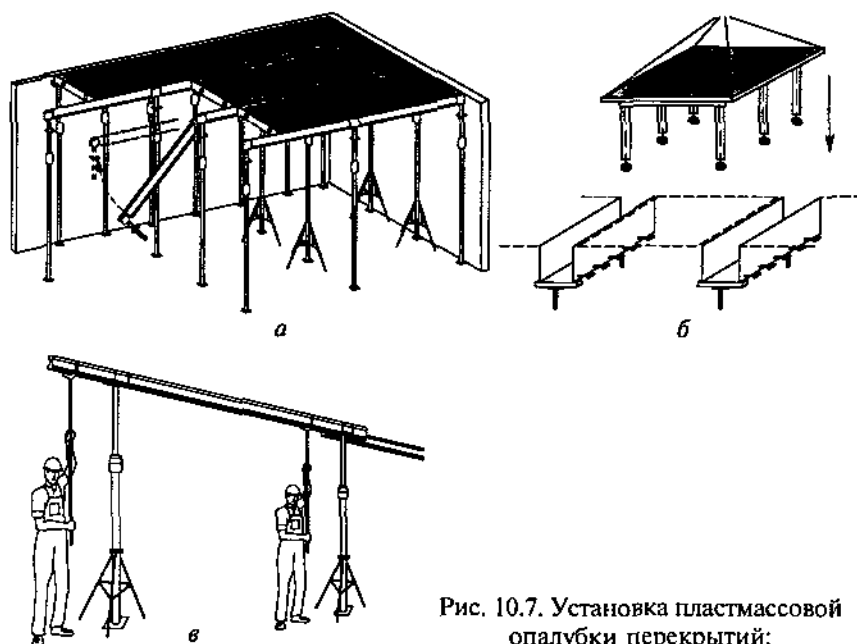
Установка пластмассовой опалубки перекрытий:
